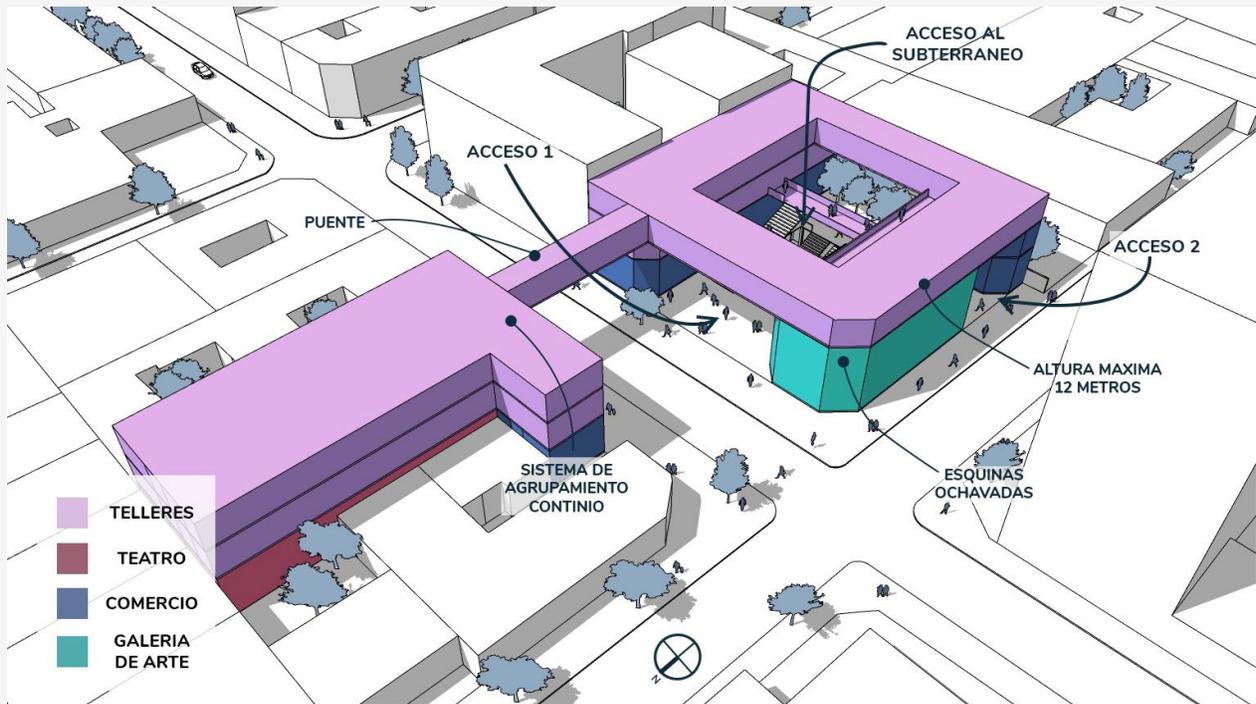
Vista 1 Fuente: Elaboración propia.
